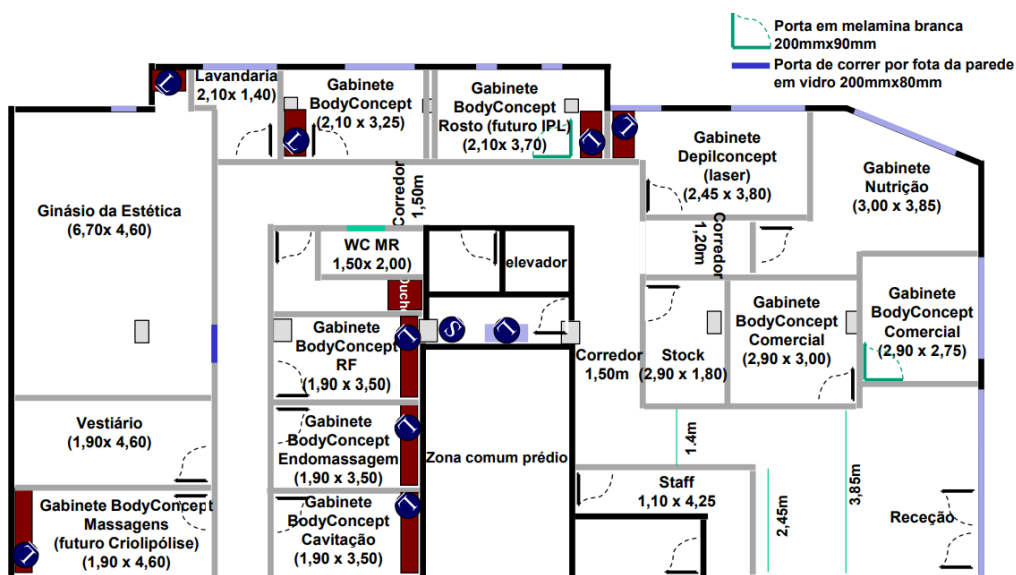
Figura X - Layout empresa franchisada (Fonte: empresa franchisada)
